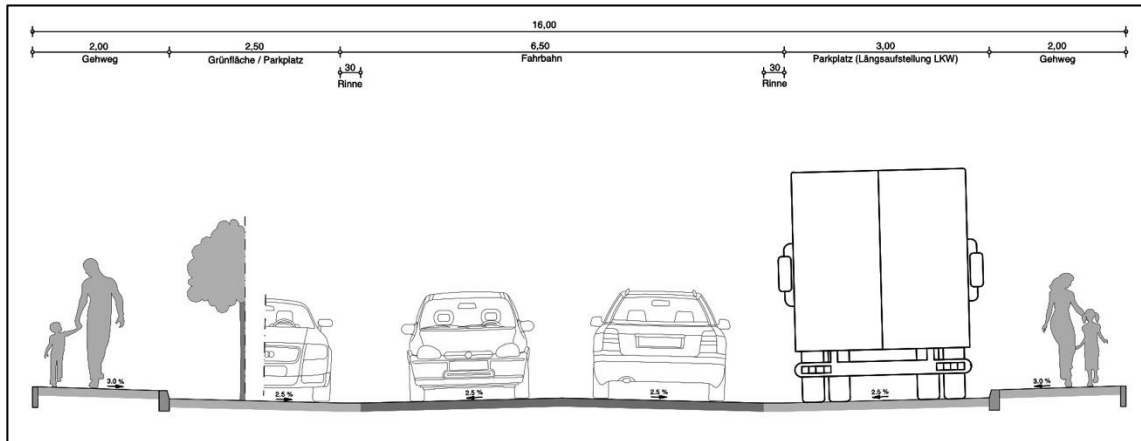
Straßenquerschnitt - Haupterschließungsachse (Verfasser: HS Ingenieure)
